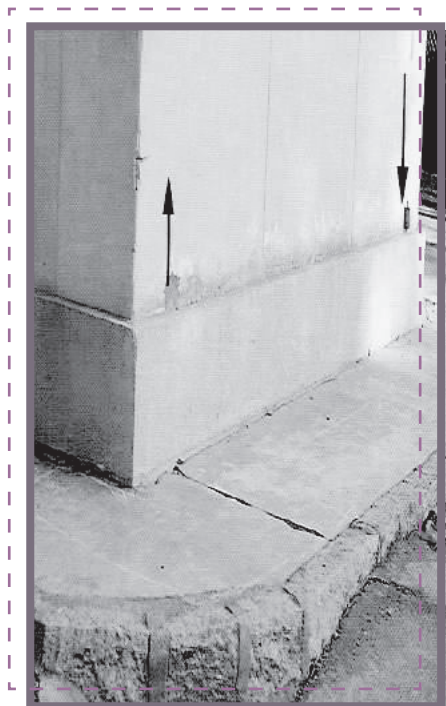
Imagen de fisuras por inclinación del edificio.
